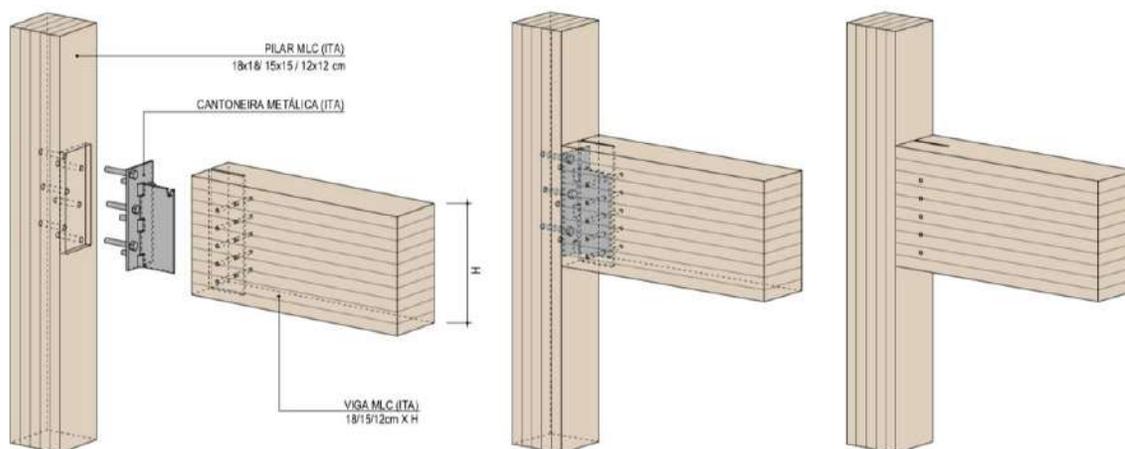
Detalhamento construtivo da fixação da viga em MLC no pilar em MLC. (fonte: Ita Construtora)
